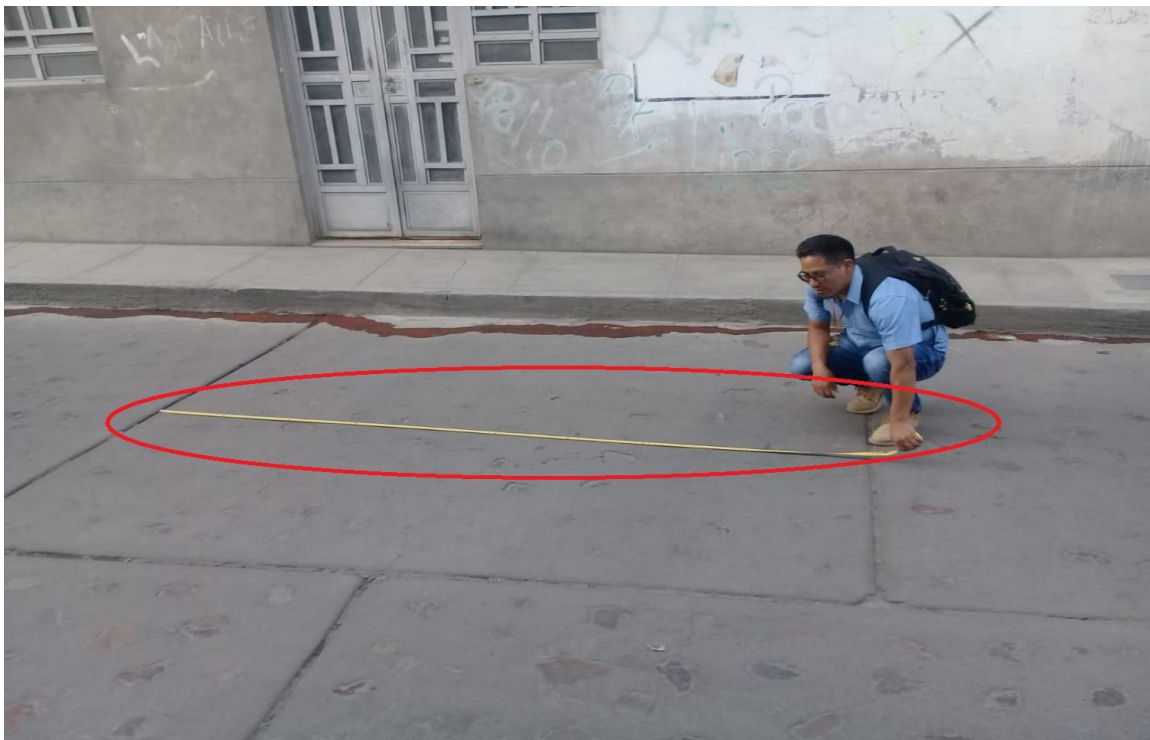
Jr. Sucre muestra n° 04 tipo de falla Grieta transversal.
